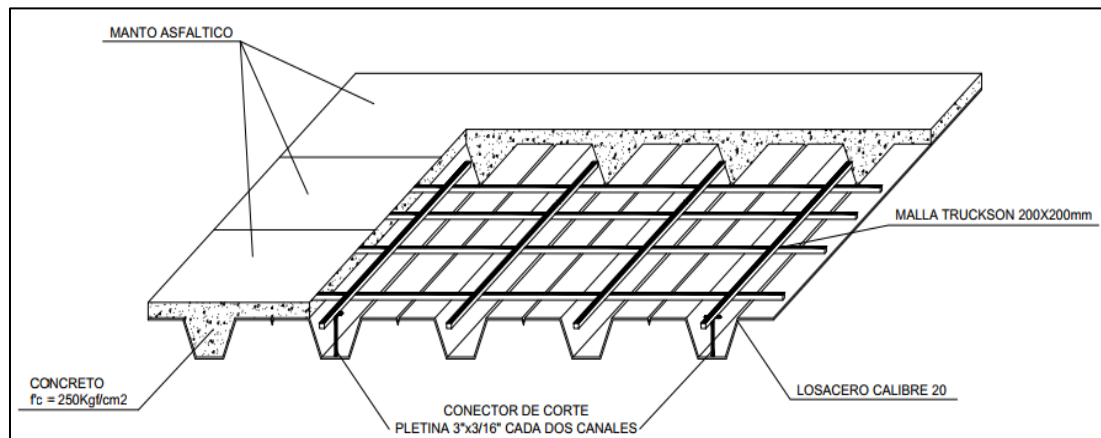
Losacero empleada en techo Nivel N+7.25.
